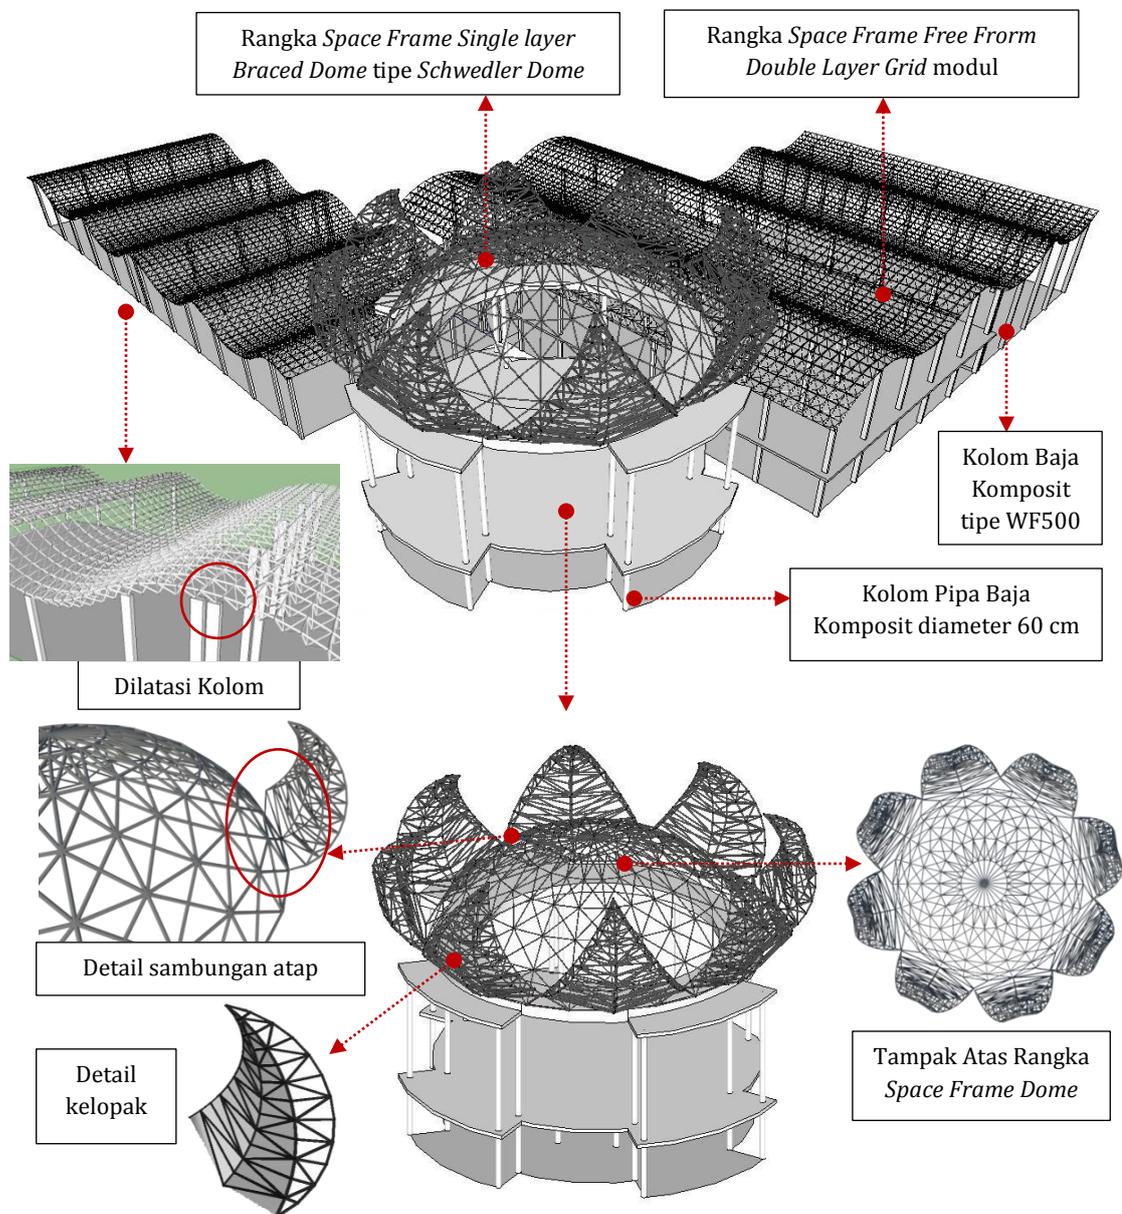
Detail *Space Frame* pada fasad bagian barat Malang Convention Center
